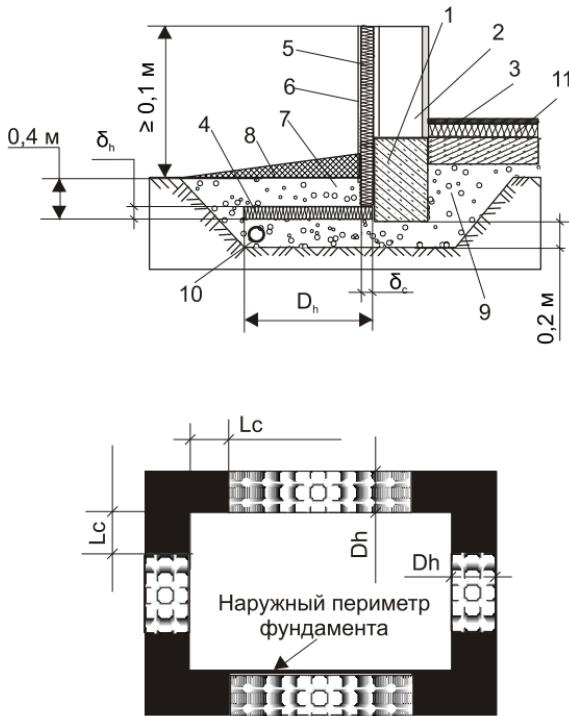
Схема укладки и параметры теплоизоляции в фундаментах отапливаемых зданий с теплоизоляцией пола:
